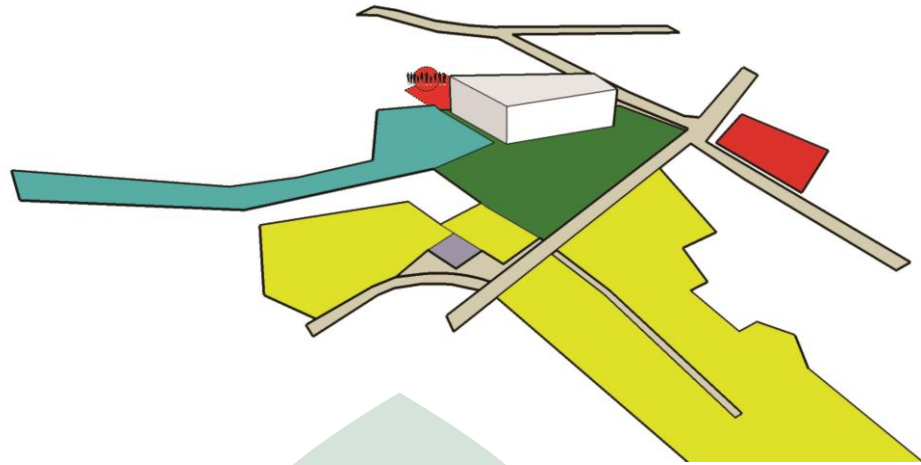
Rencana Sirkulasi Tapak Alternatif 1
